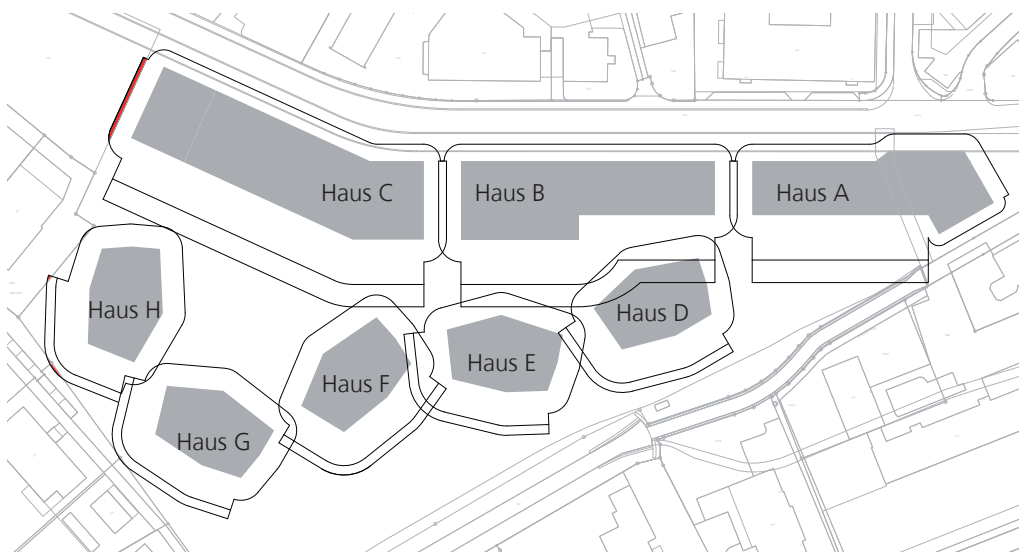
Grenzabstände, Strassenabstände, Mehrlängenzuschläge
